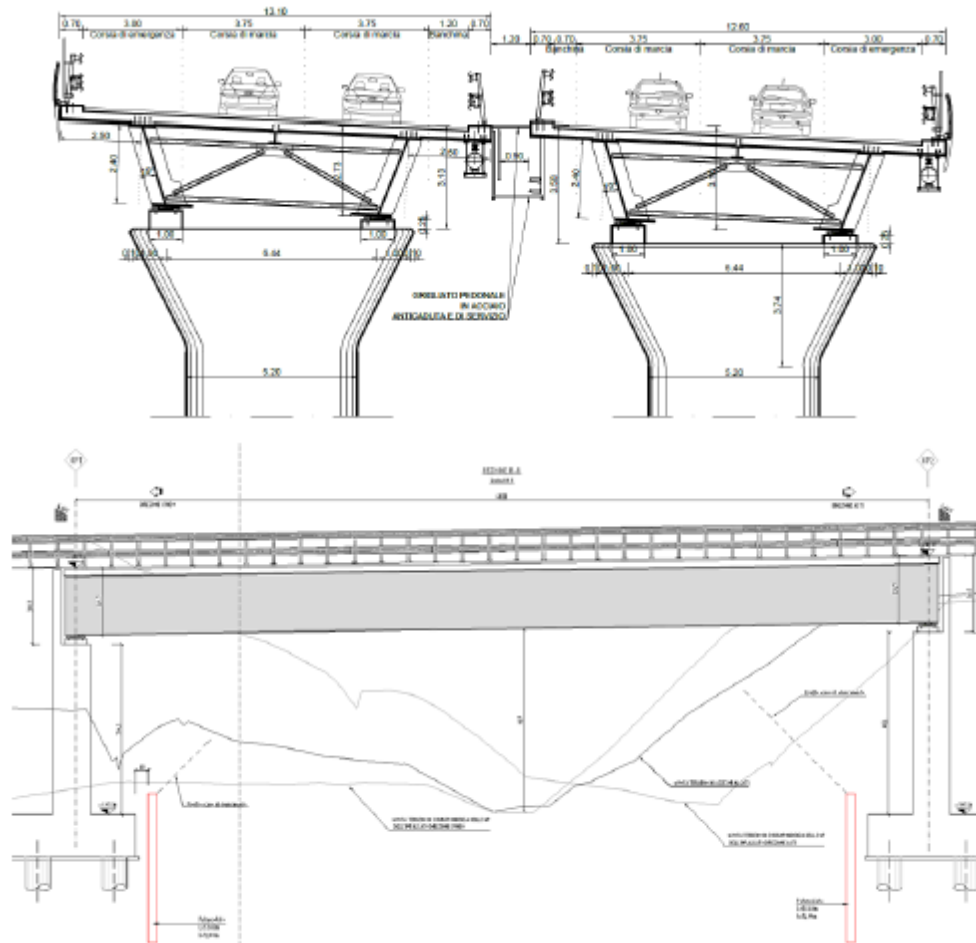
Ponte Rio dei Deglia: sezione trasversale, sezione longitudinale.
